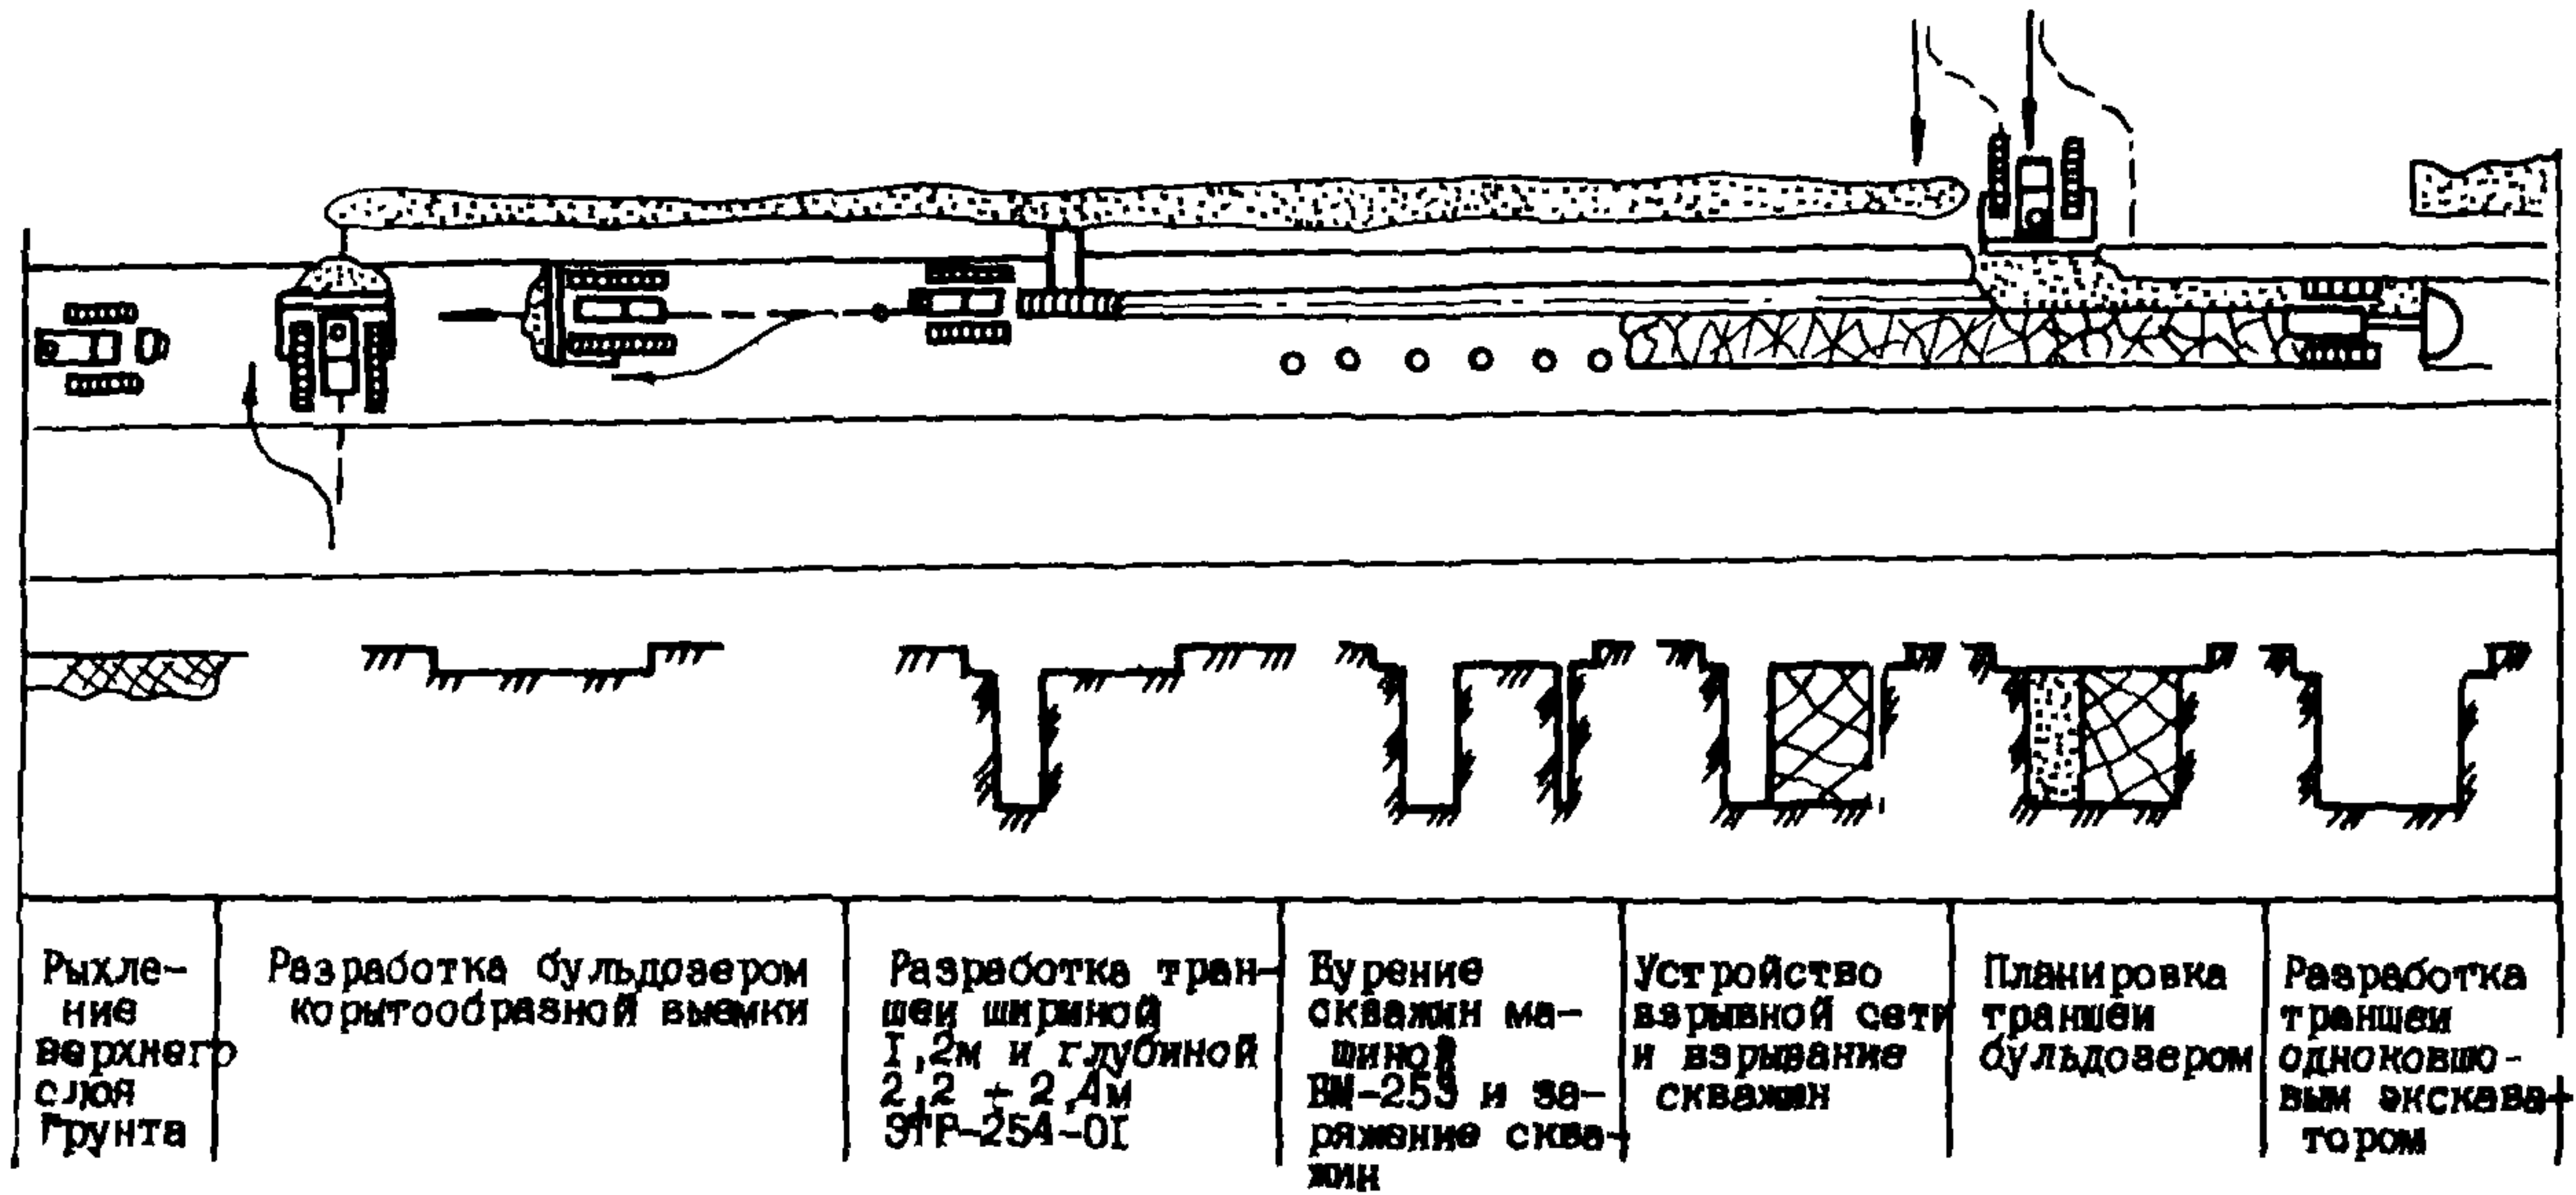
Г. Разработка траншеи в мерзлых грунтах крепостью до 400 ударов
